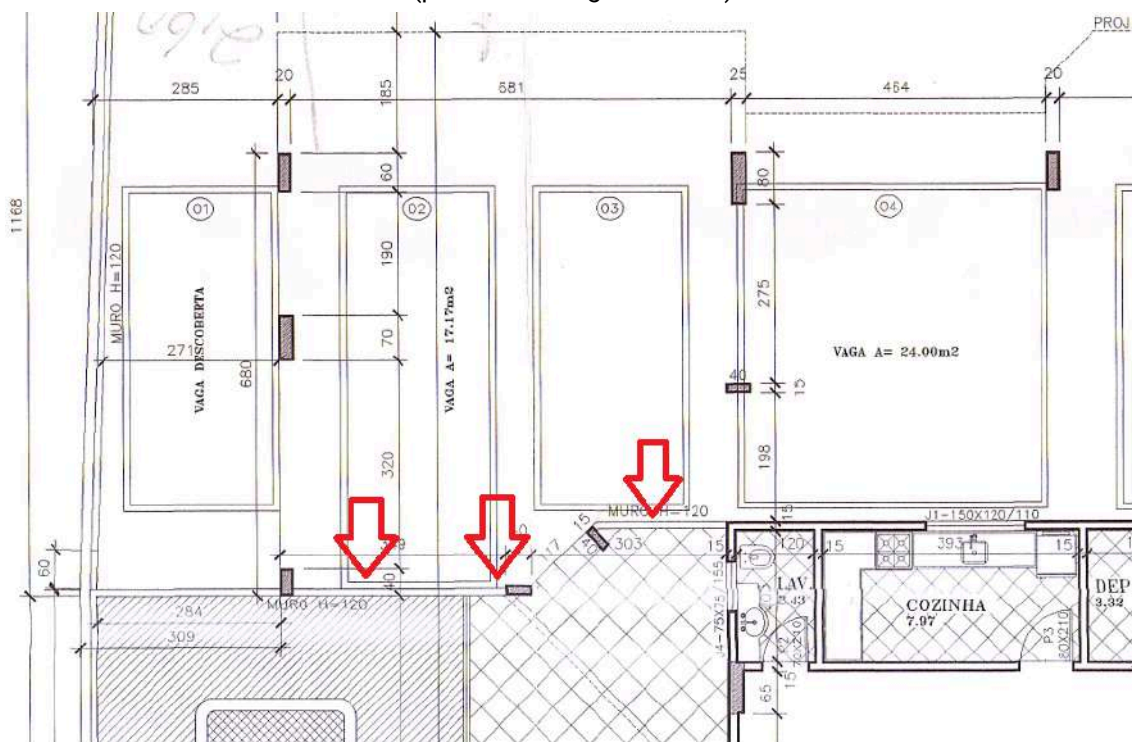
Indicação em planta do empolamento/deslocamento do revestimento em parede da garagem térrea (próximo às vagas 02 e 03)
